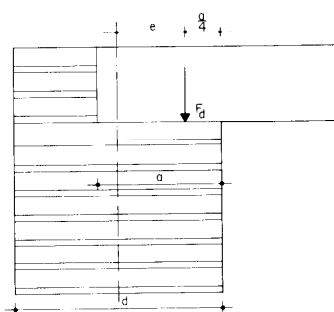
Forjado sustentado en un muro extremo, sin muro de carga sobre el forjado
